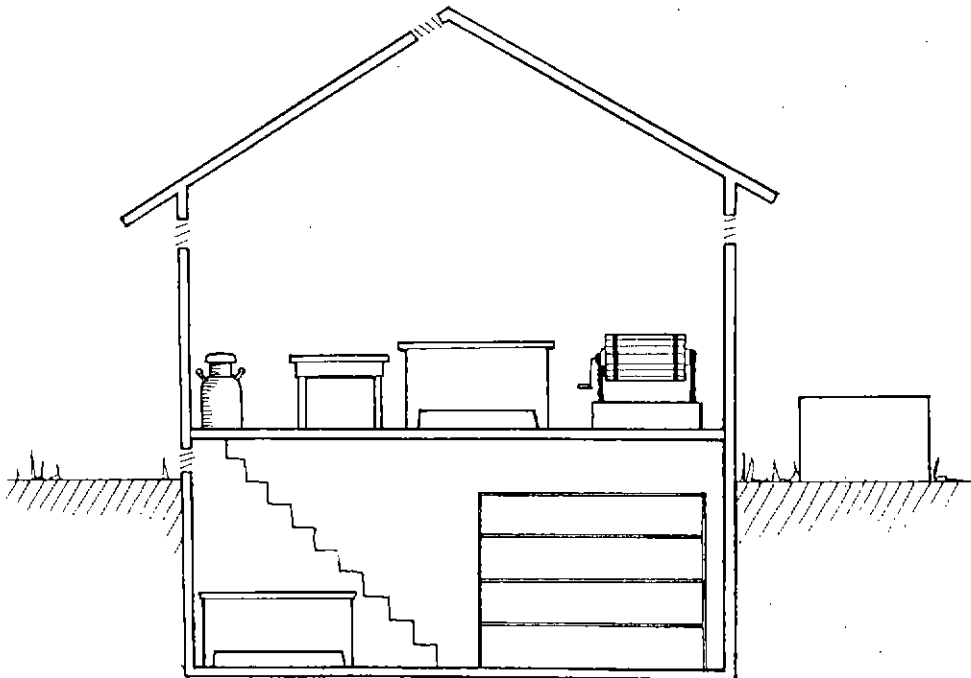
Sección del edificio que muestra la habitación de maduración en la planta baja
